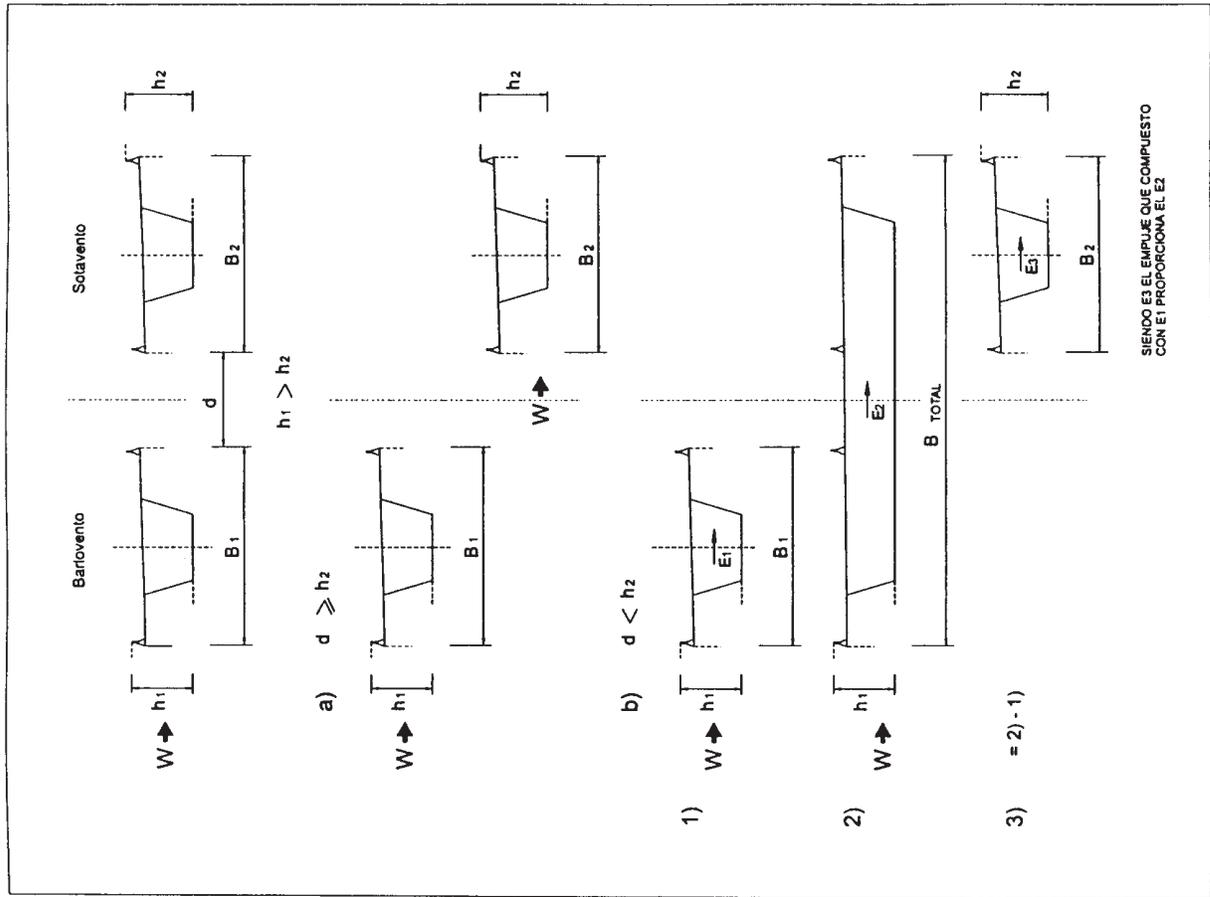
EMPUJE TRANSVERSAL SOBRE TABLEROS DE ALMA LLENA
